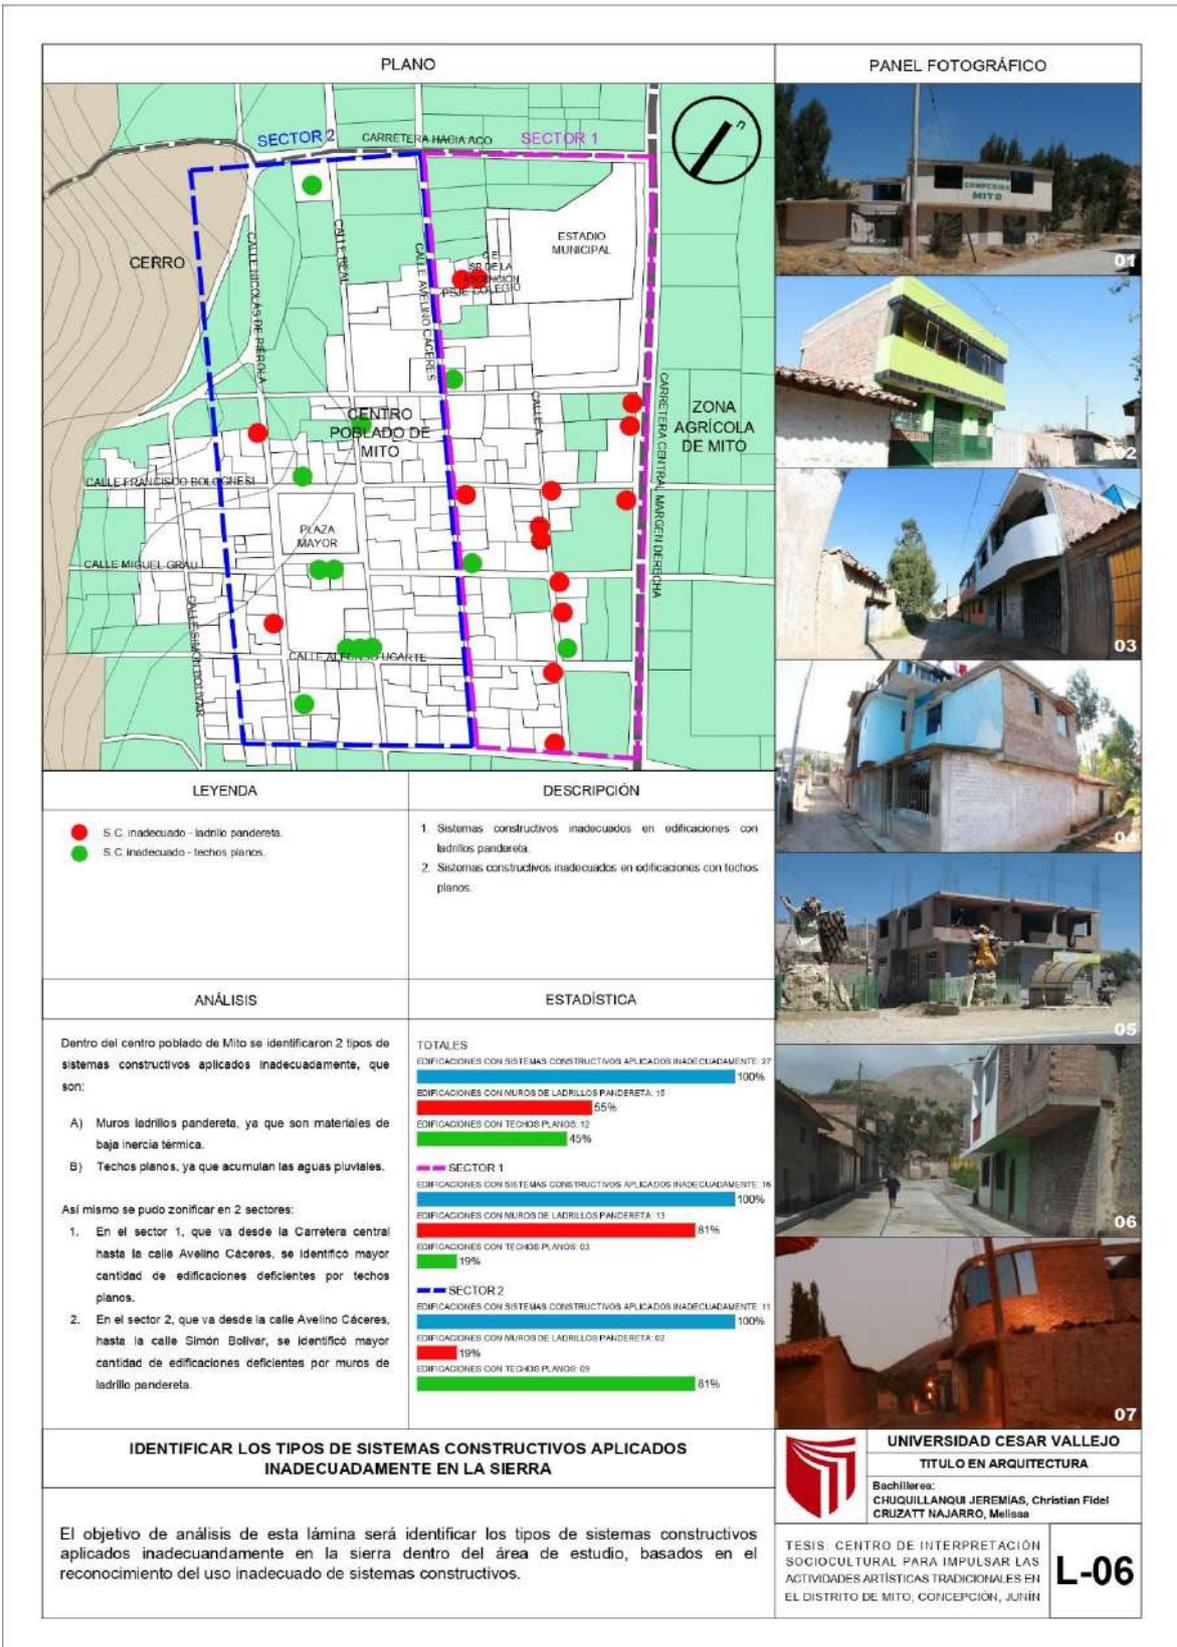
Lamina 06 - Identificar los tipos de sistemas constructivos aplicados inadecuadamente en la sierra. Elaboración propia.
